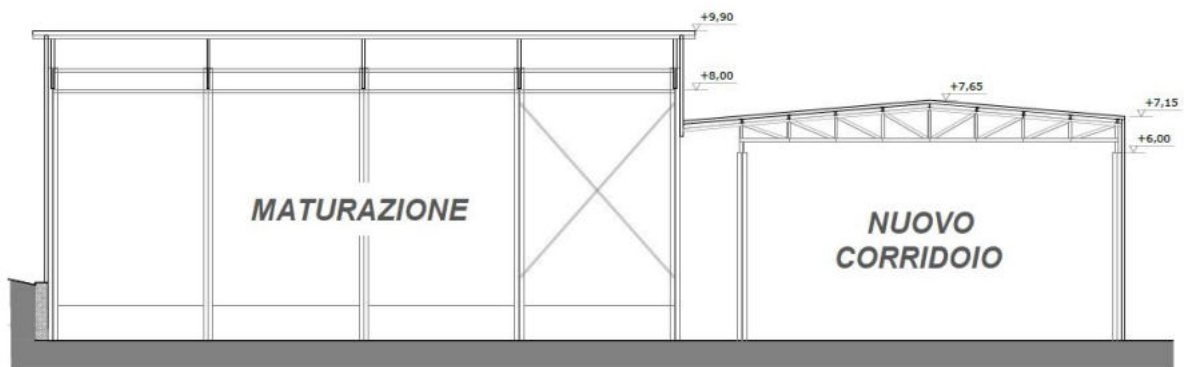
DETTAGLIO SEZIONE – Dettaglio del Nuovo Corridoio in rapporto alla tettoia esistente
